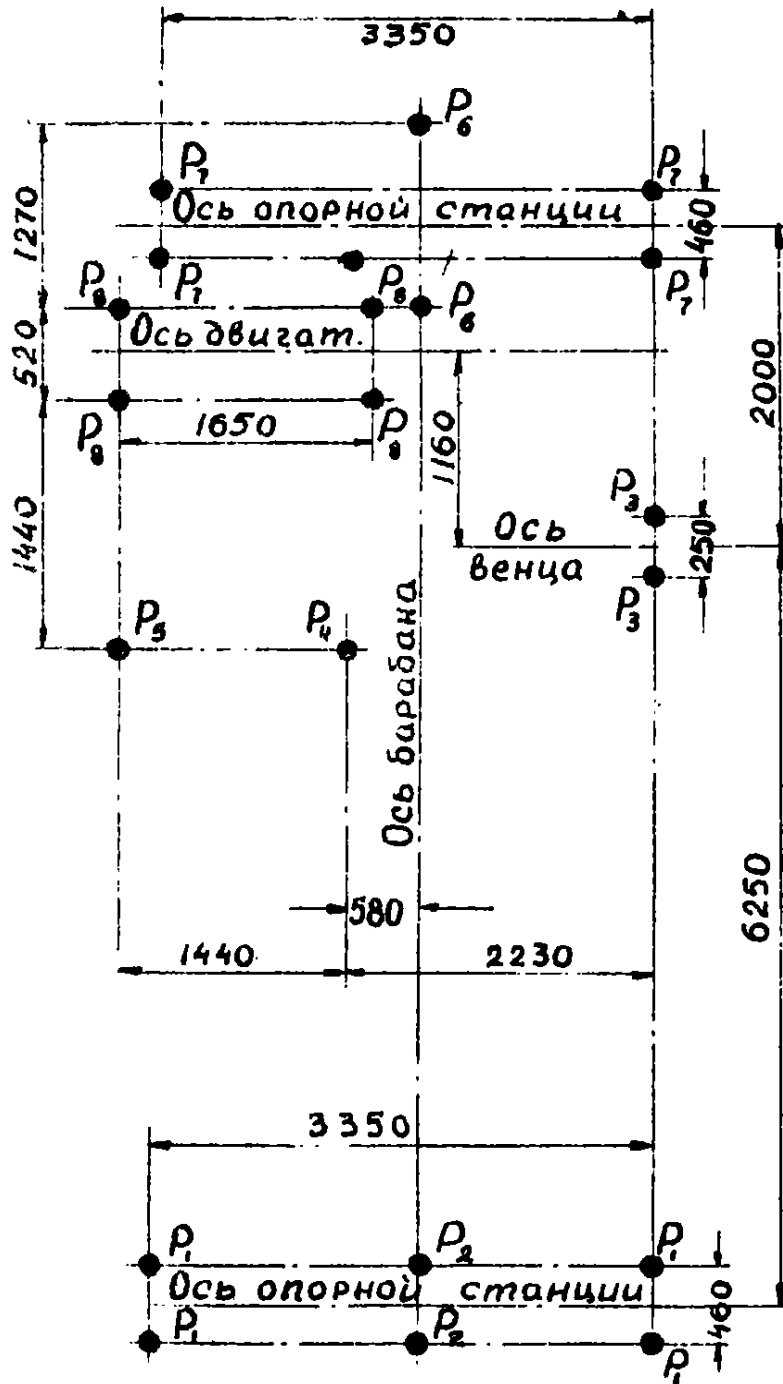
Схема распределения нагрузки на опоры от сушильного барабана 2,2x14,0м
